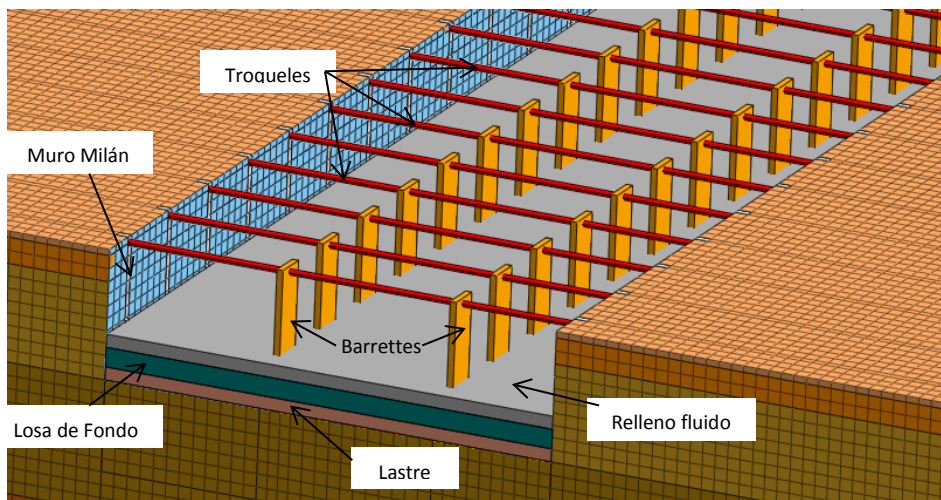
Colocación de lastre, construcción de losa de fondo y relleno fluido.
